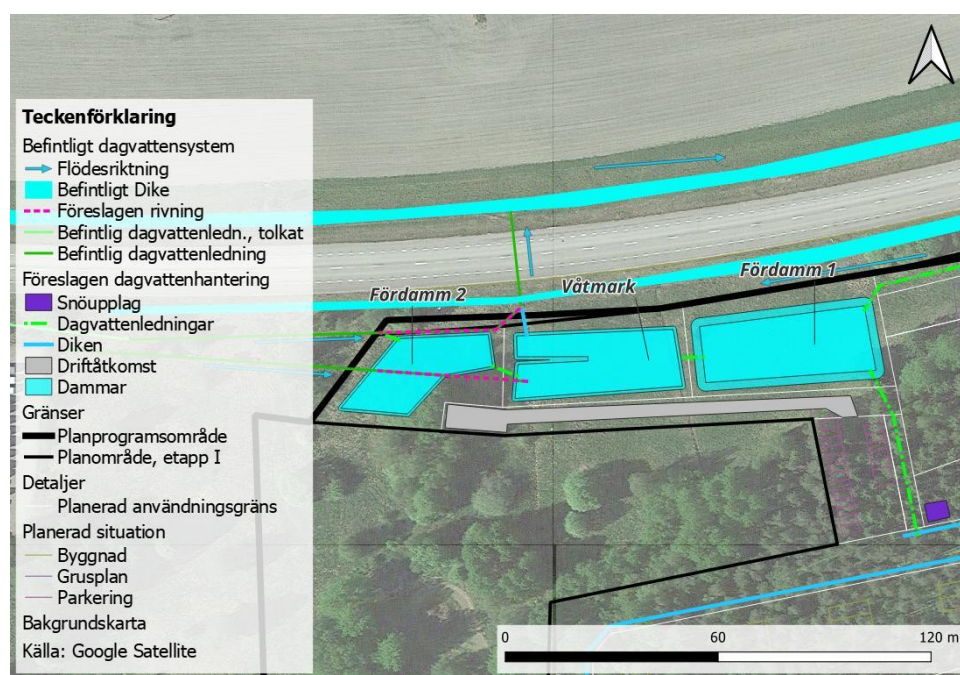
Planerad dagvattenhantering med diken, dammar och våtmark (Ramboll 2023).
